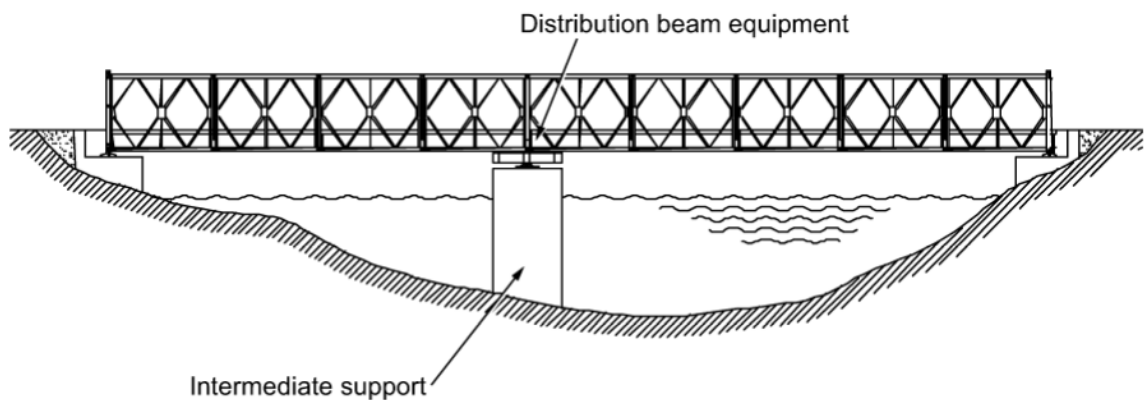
Distribution Beam Equipment*. Adaptado de Mabey Bridge (2014)
